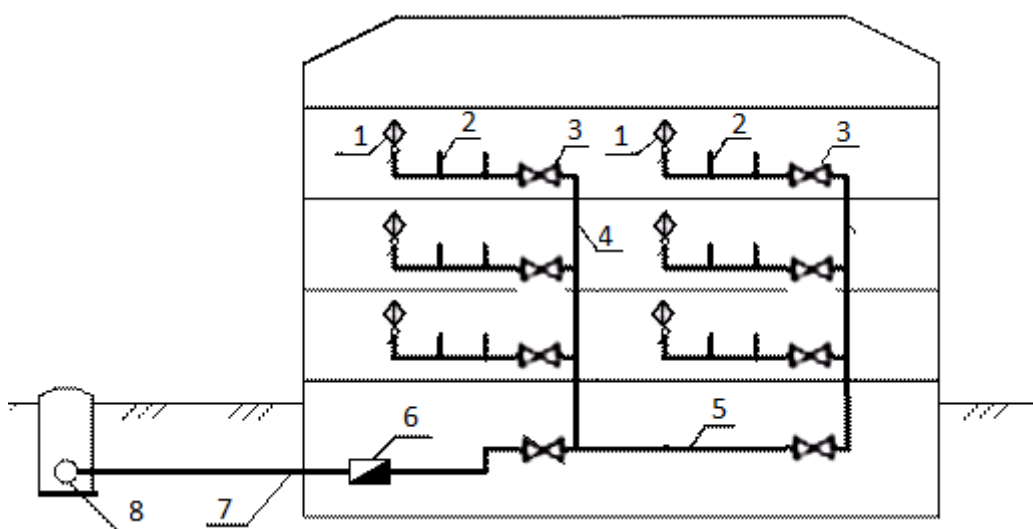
Основные элементы внутреннего водопровода: 1 – водоразборная арматура; 2 – подводки к приборам; 3 – запорная арматура; 4 – стояк; 5 – разводящая сеть (магистраль); 6 – водомерный узел; 7 – ввод; 8 – трубопровод наружной водопроводной сети
